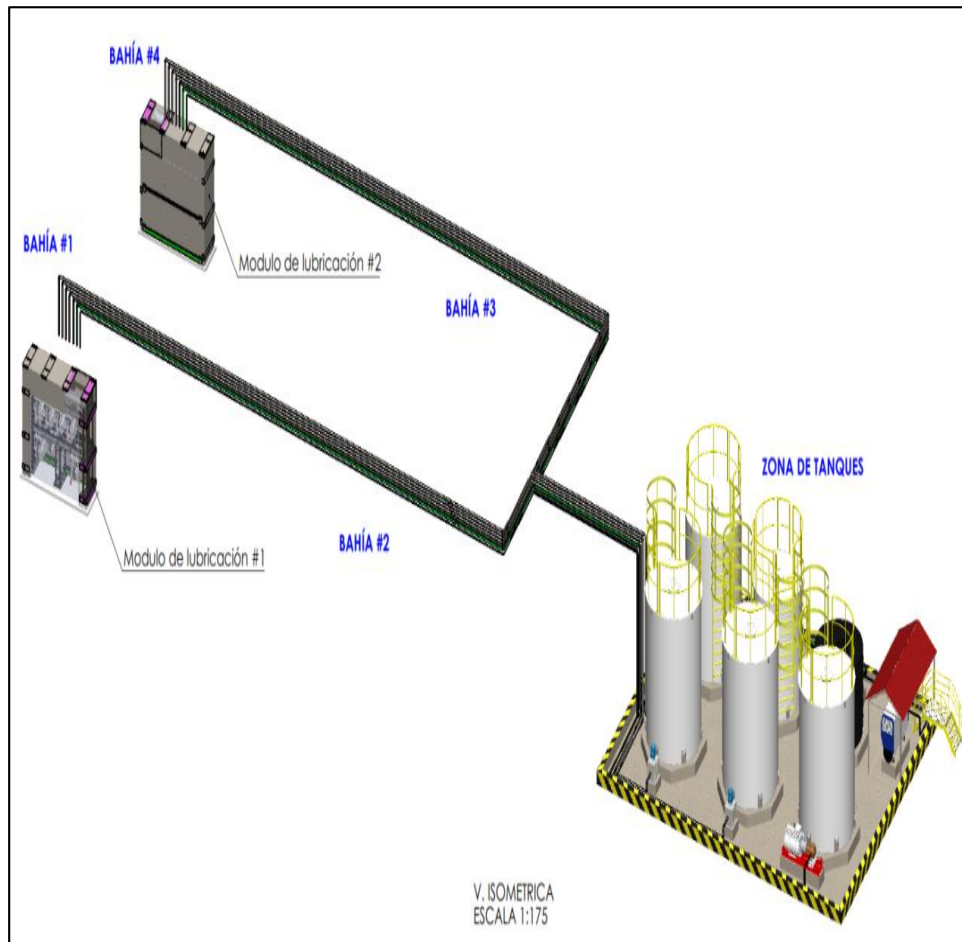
Sistema de despacho de lubricantes en la Bahía de Lubricación con la propuesta.
